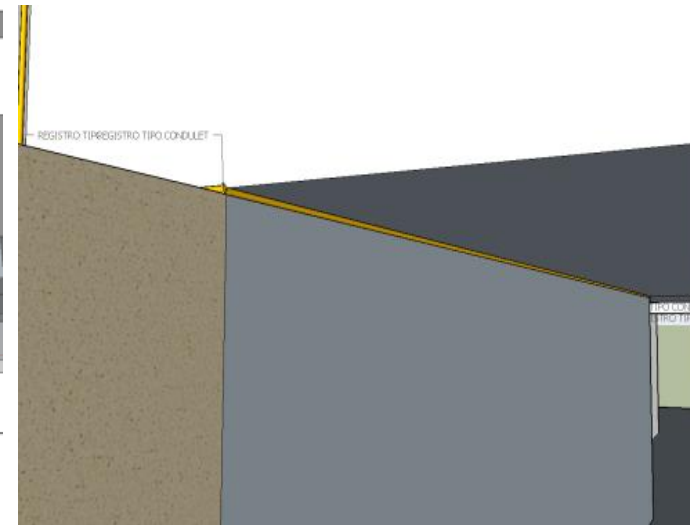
Plano 3D de ruta de tubería, vista 6: aporte propio.
